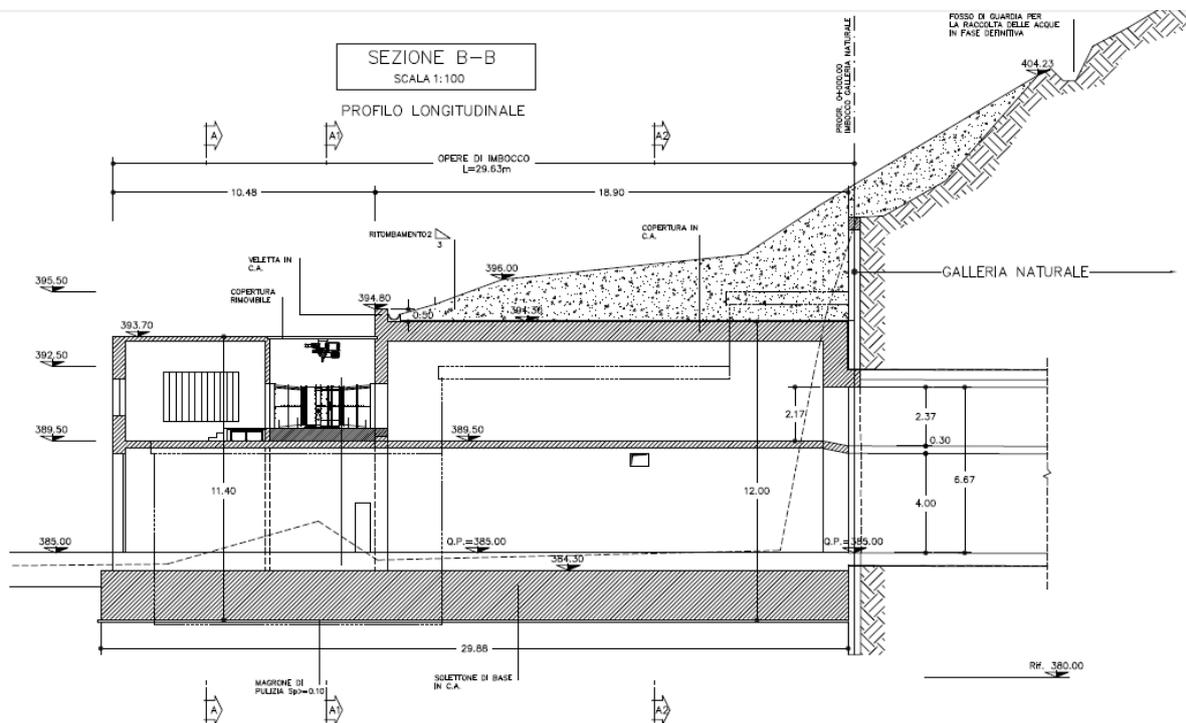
Profilo longitudinale della zona di imbocco e della centrale di ventilazione
